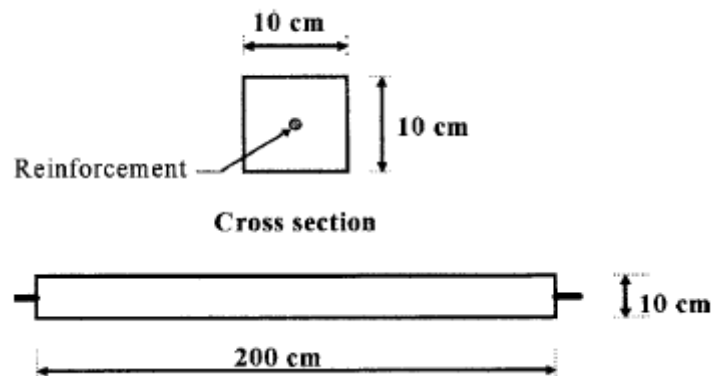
Detalles del Tirante: Corte transversal. (Cracking Behavior of Reinforced High-Strength Concrete Tension Ties, Llorain, Maurel y Seffo, 1998)
